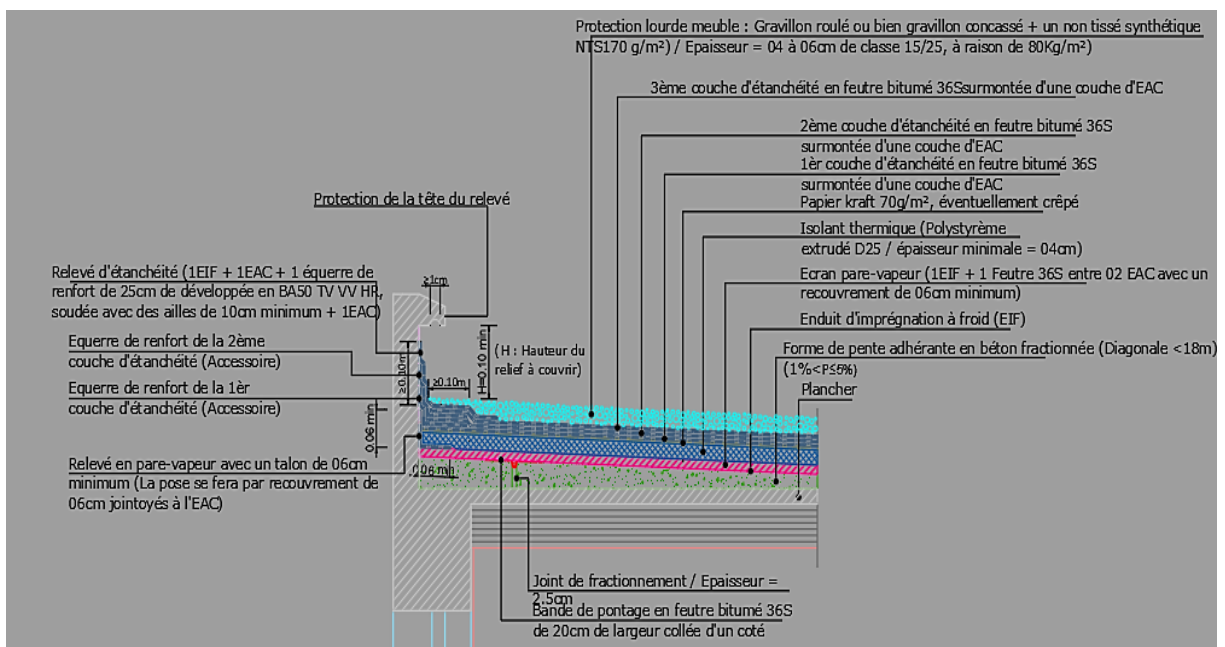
2:détail d'étanchéité-terrasse inaccessible
